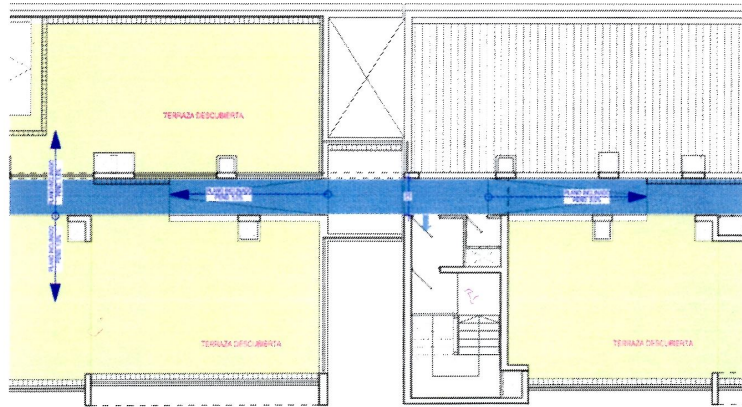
planos inclinados 5,00% con ruta de accesibilidad
